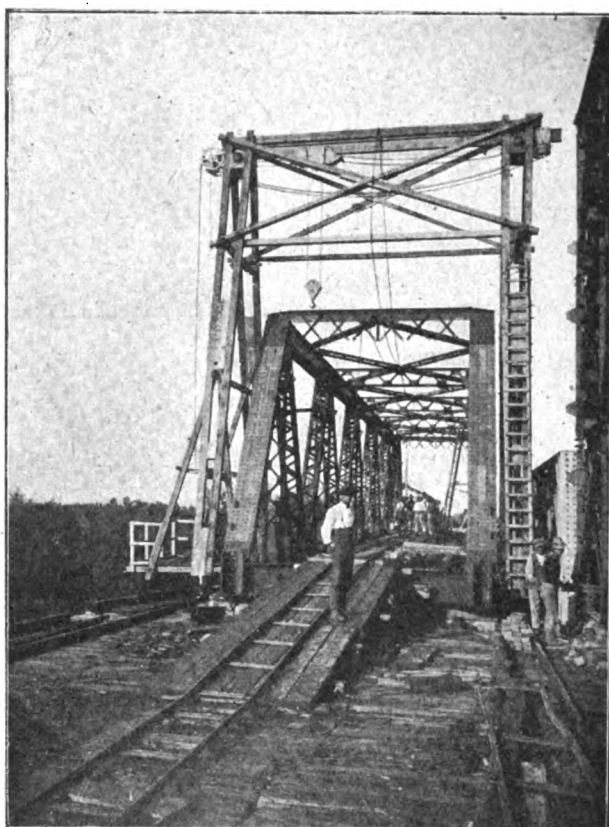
Linea Mestre-Portogruaro: Ricostruzione delle travate del ponte sul Piave fra Fossalta di Piave e S. Donà di Piave.
